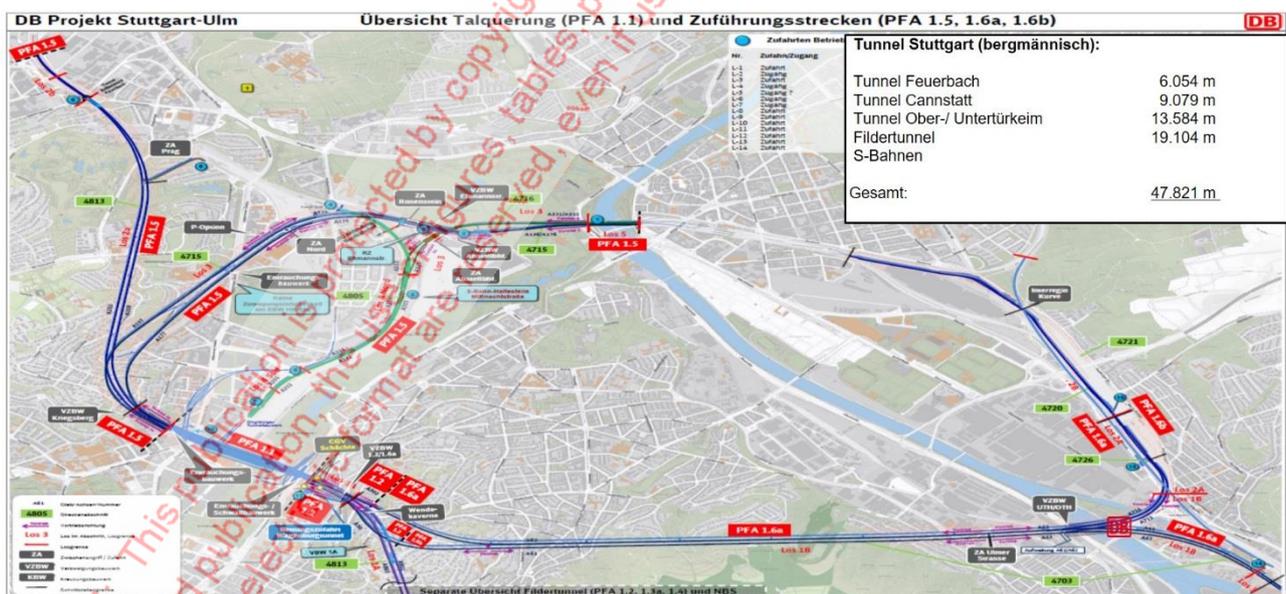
Überblick Tunnel Stuttgart (Fildertunnel, Tunnel Feuerbach, Tunnel Cannstatt, Tunnel Ober-/Untertürkheim, S-Bahnen)
